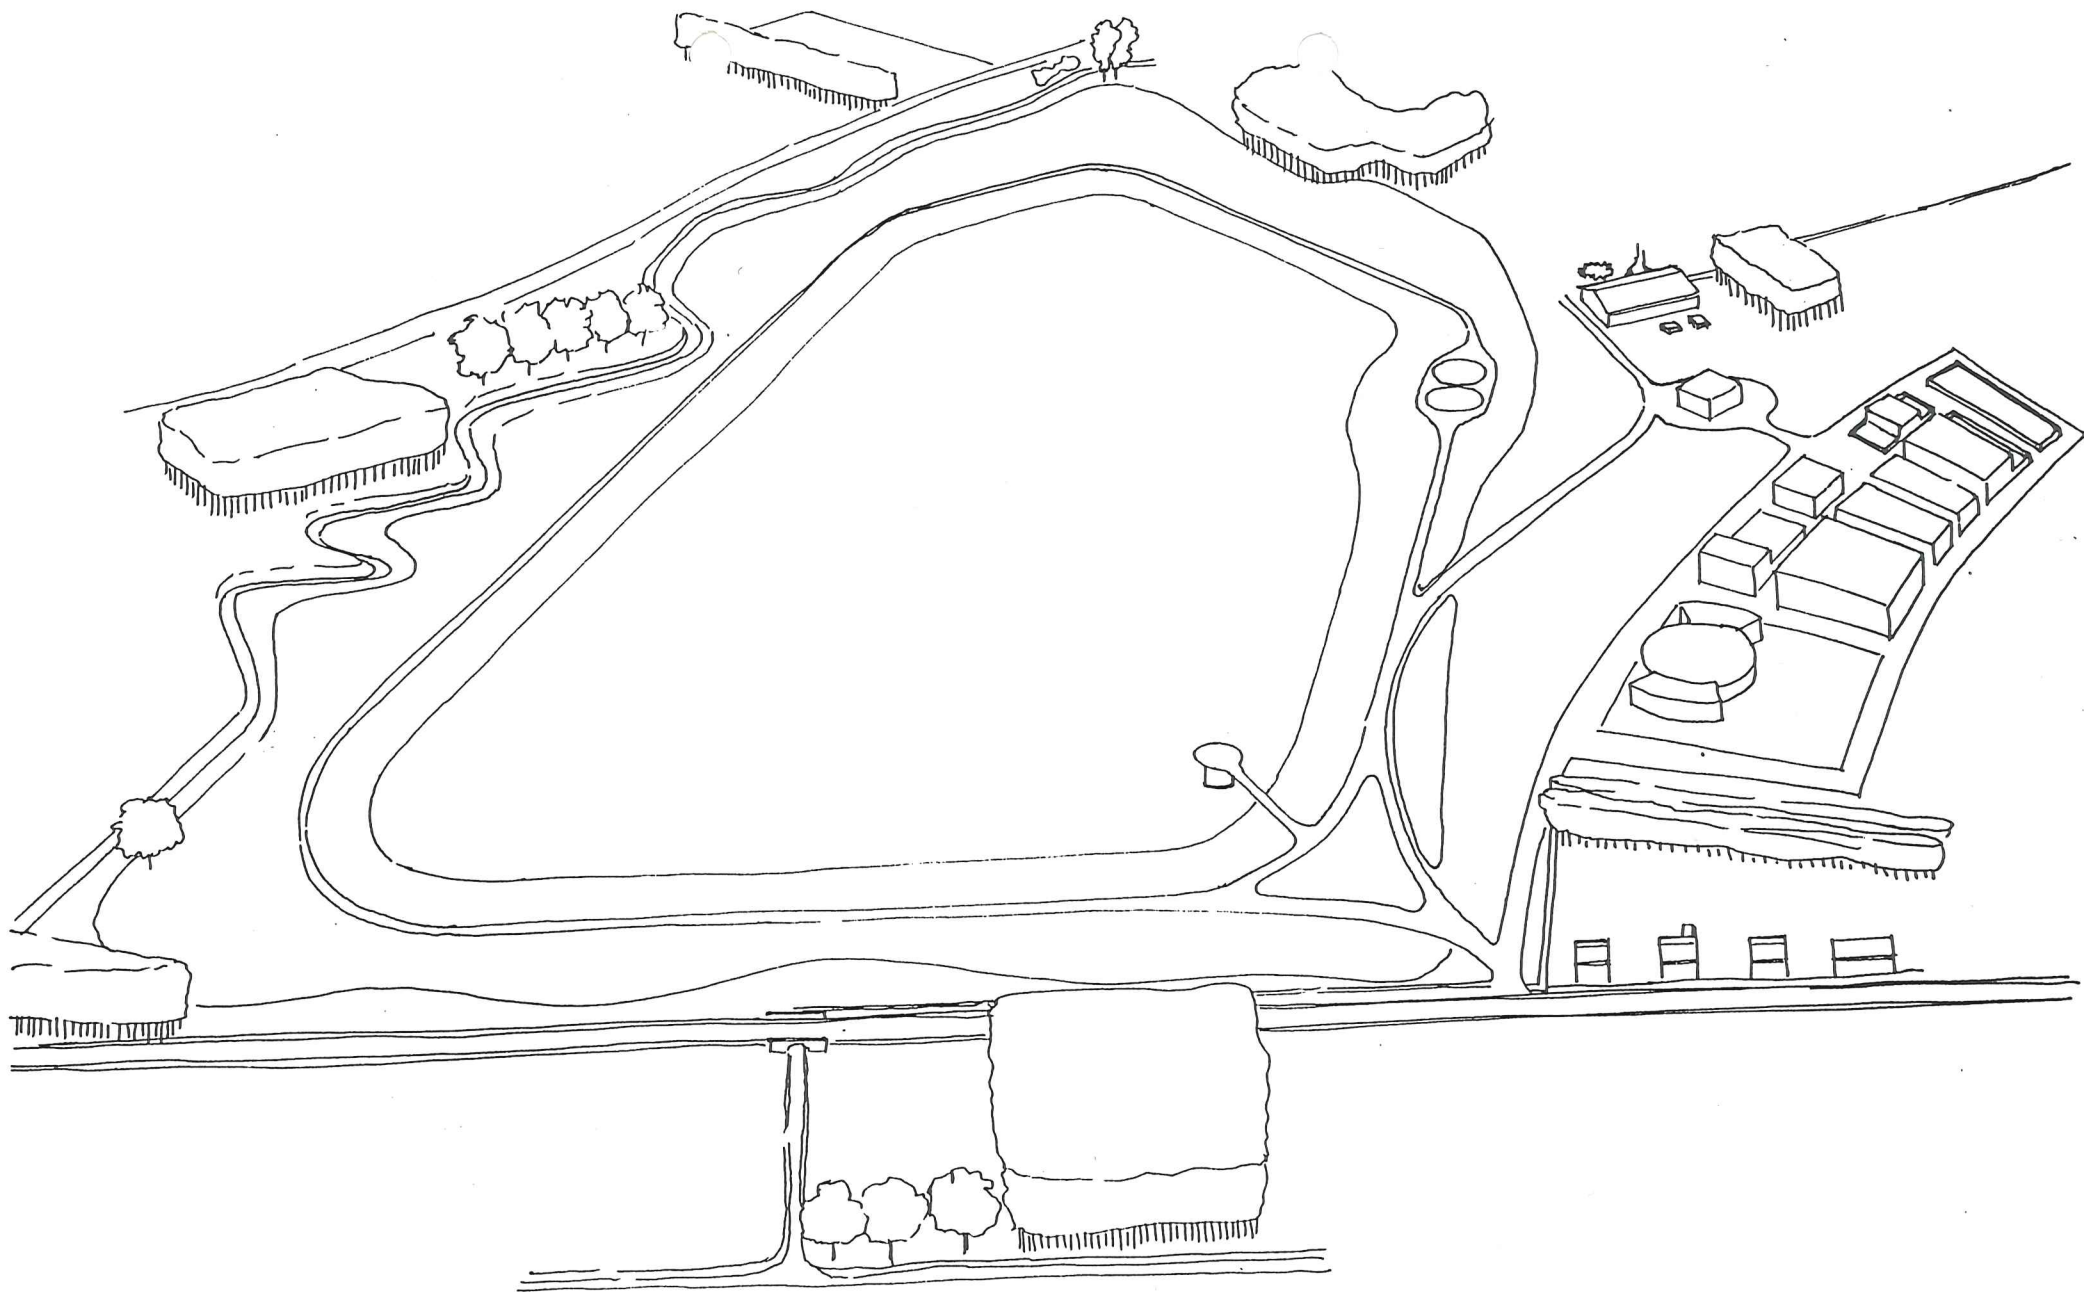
N-S perspectiefzicht op het doorstroombekken en de gebouwen
